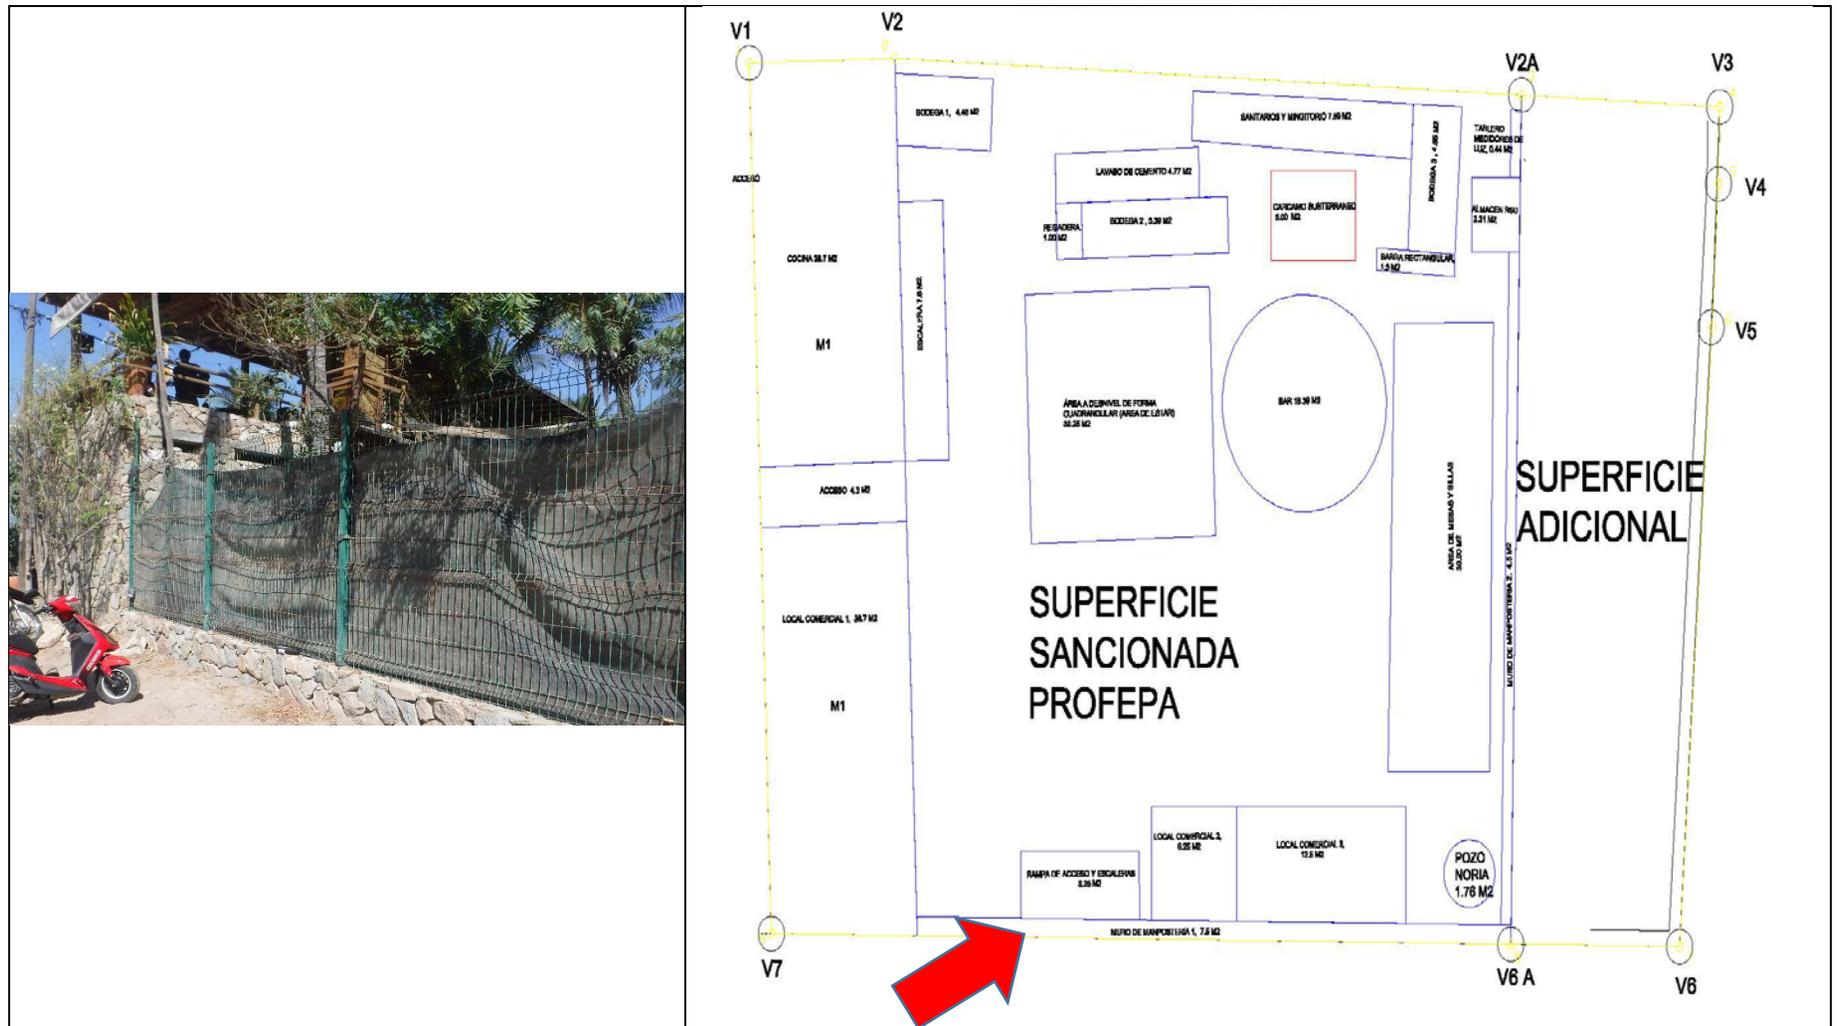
Muro de mampostería con malla metálica electrosoldada.
